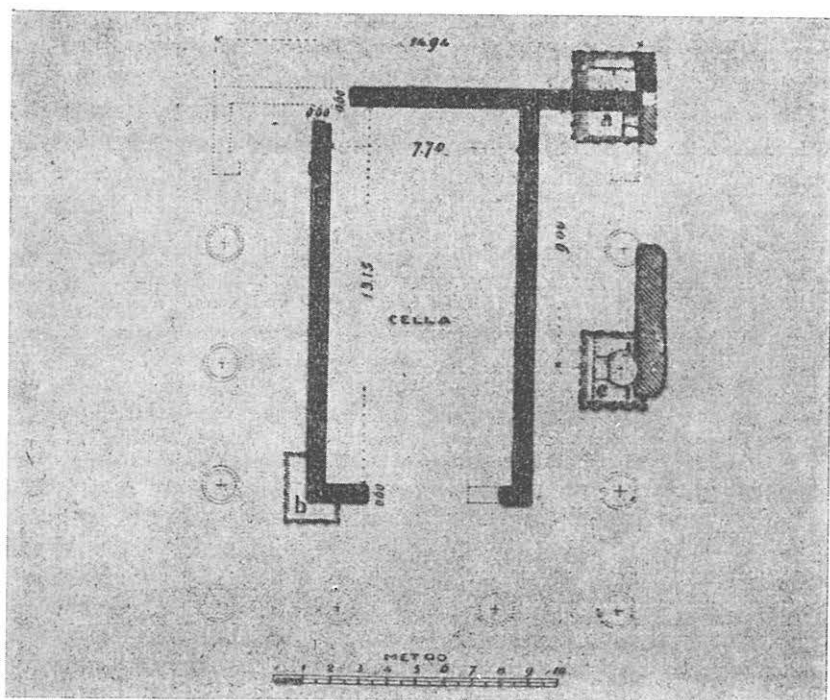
Pianta del tempio detto di Diana, secondo il Florescu.
